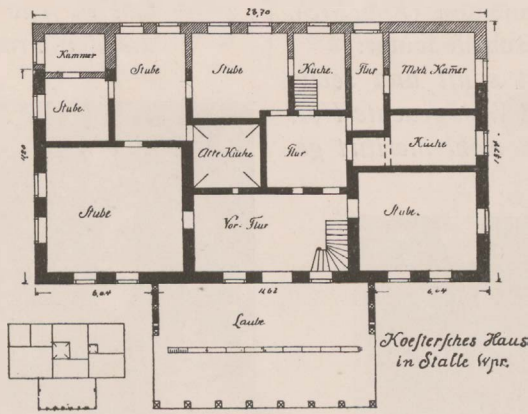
Grundriß des Hauses Koester in Stalle. M. 1 : 400.
